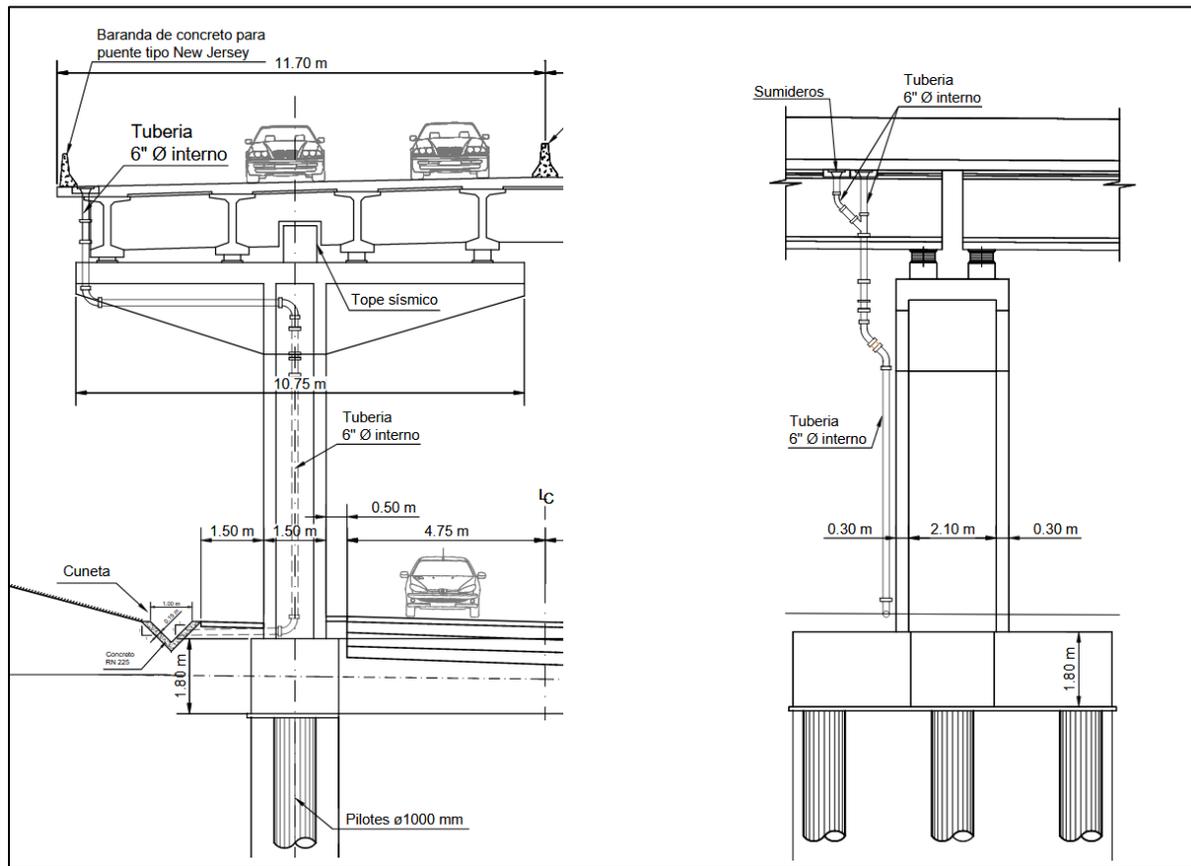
Detalle del sistema de drenaje del viaducto, como se muestra en los planos de la Unidad Funcional III. El detalle no muestra los cajones de concreto observados en sitio.
